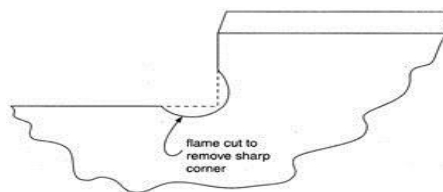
Corrección del recubrimiento de corte cuadrado mediante corte de llama; (Instituto Americano de Construcción de Acero, 2006)
